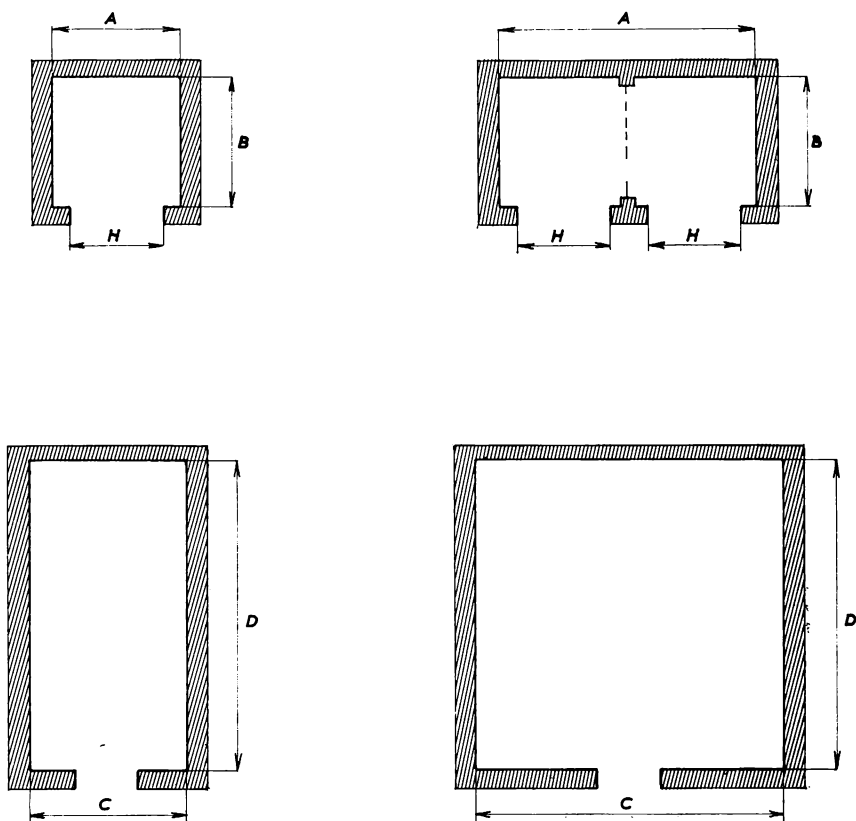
Dimensions des gaines et des machineries d'après le D.T.U.
